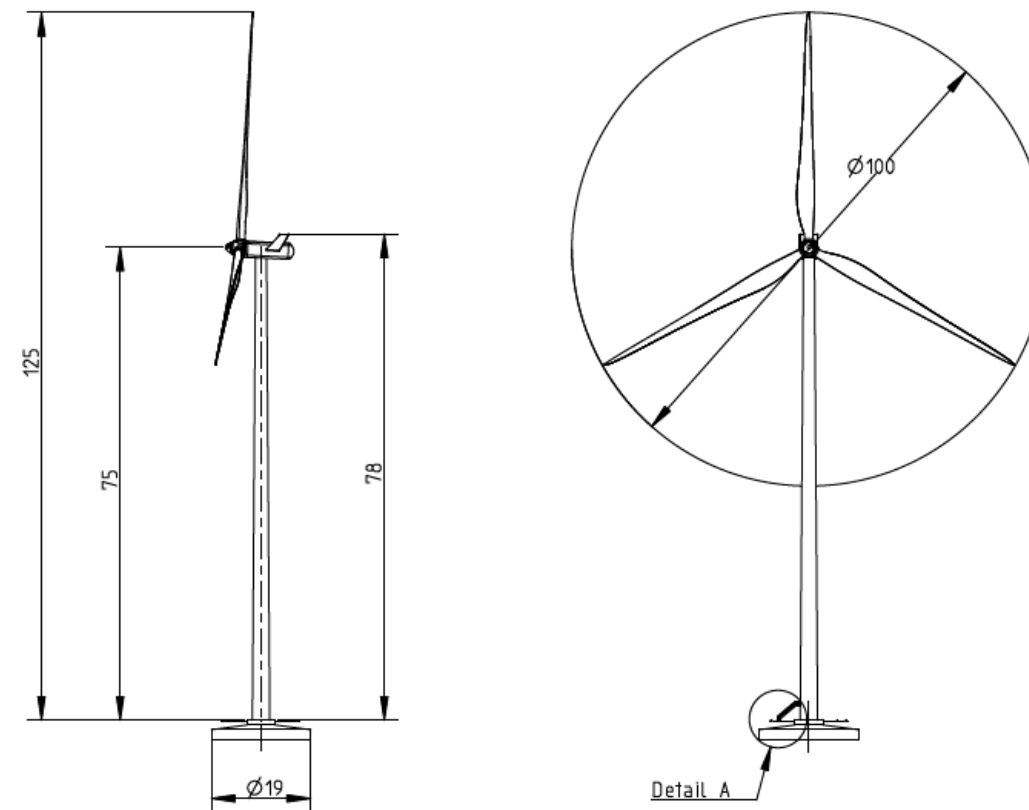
Vue en plan de la Vestas V100-2.2 MW
